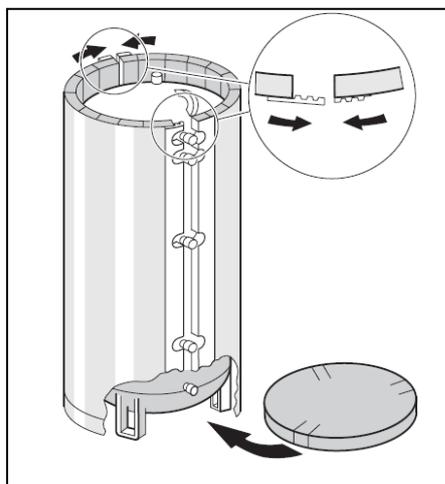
Монтаж теплоизоляции (принципиальная схема)
